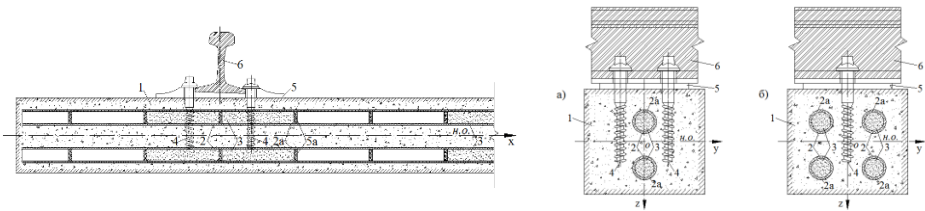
композиционная шпала, армированная бамбуковыми стержнями (1 – полимерная матрица; 2 – бамбуковые элементы; 2а – их стенки; 3 – затвердевший цементный раствор; 4 – шурупы или костыли; 5 – рельсовая подкладка; 5а – междуозлия бамбуковых элементов; 6 – рельсы)
